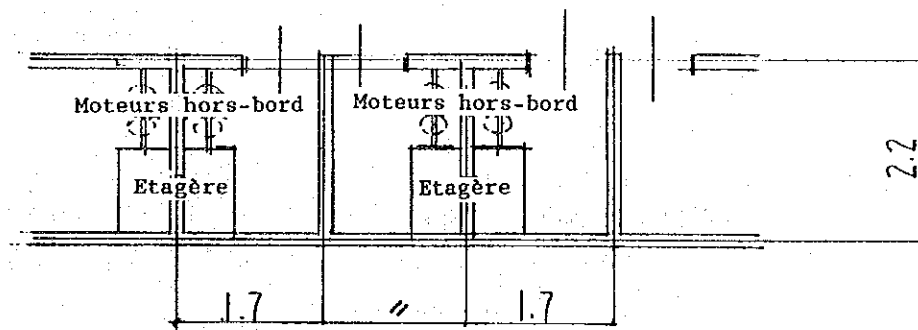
Projection sur le plan horizontal du magasin pour les pêcheurs
